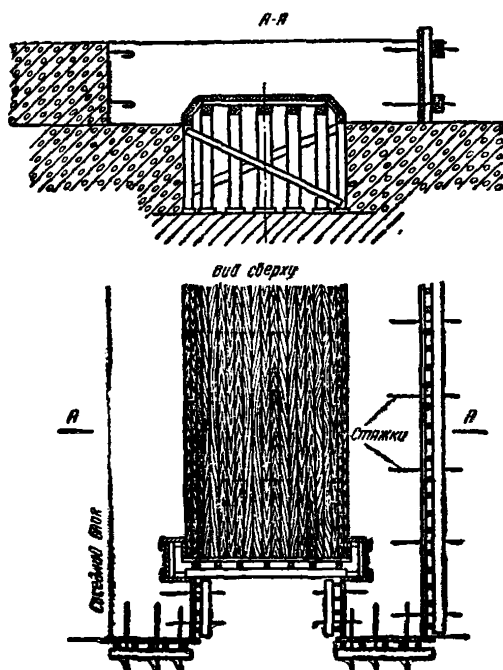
Стационарная опалубка на опорных конструкциях галерей и водоводов постоянного сечения с плоским перекрытием
